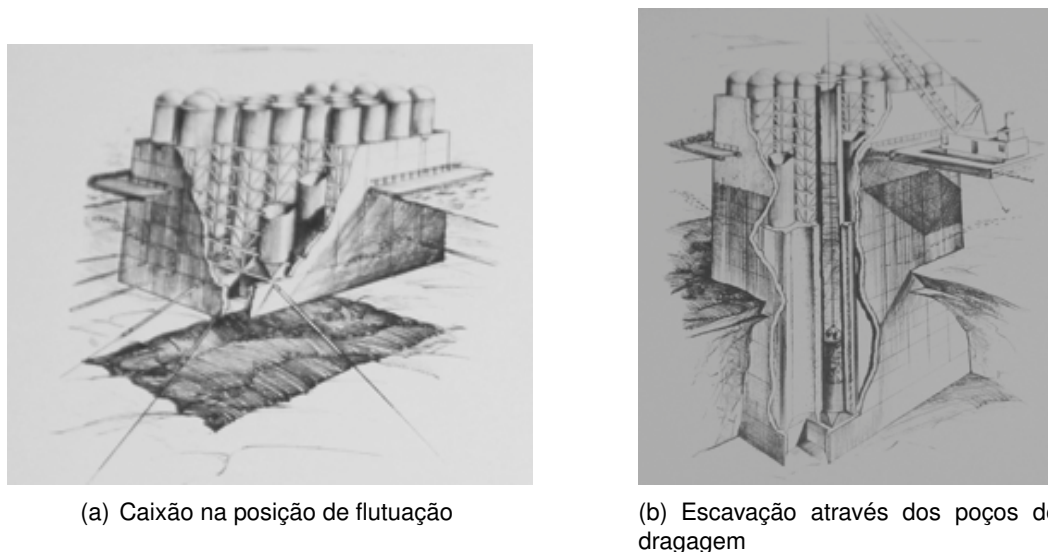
Processo de construção do maciço de apoio do pilar P3 [13]
